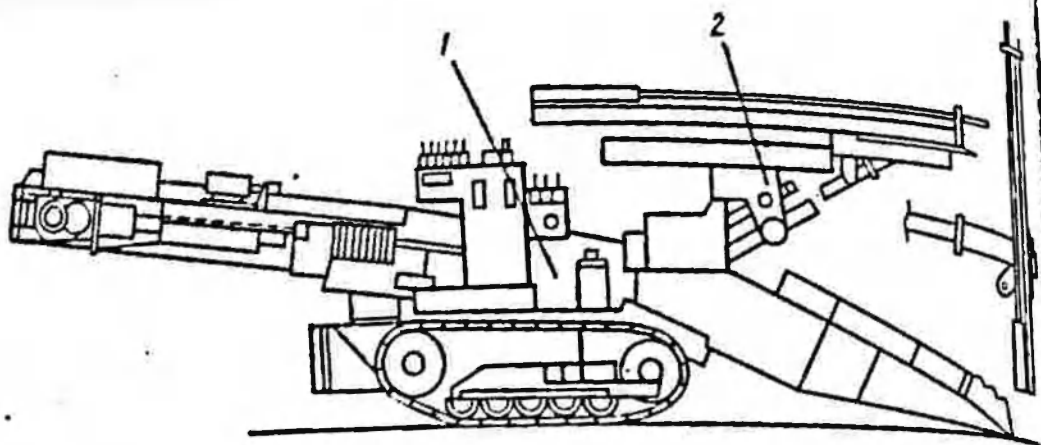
Буропогрузочный агрегат БА-ПНБ-3Д
